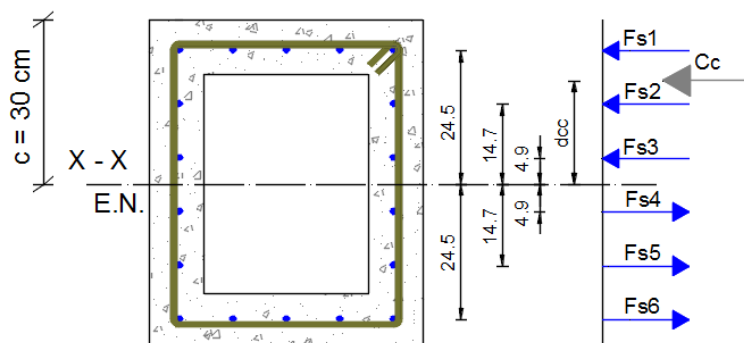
Esquema general de deformaciones, esfuerzos y fuerzas en la sección transversal rectangular
